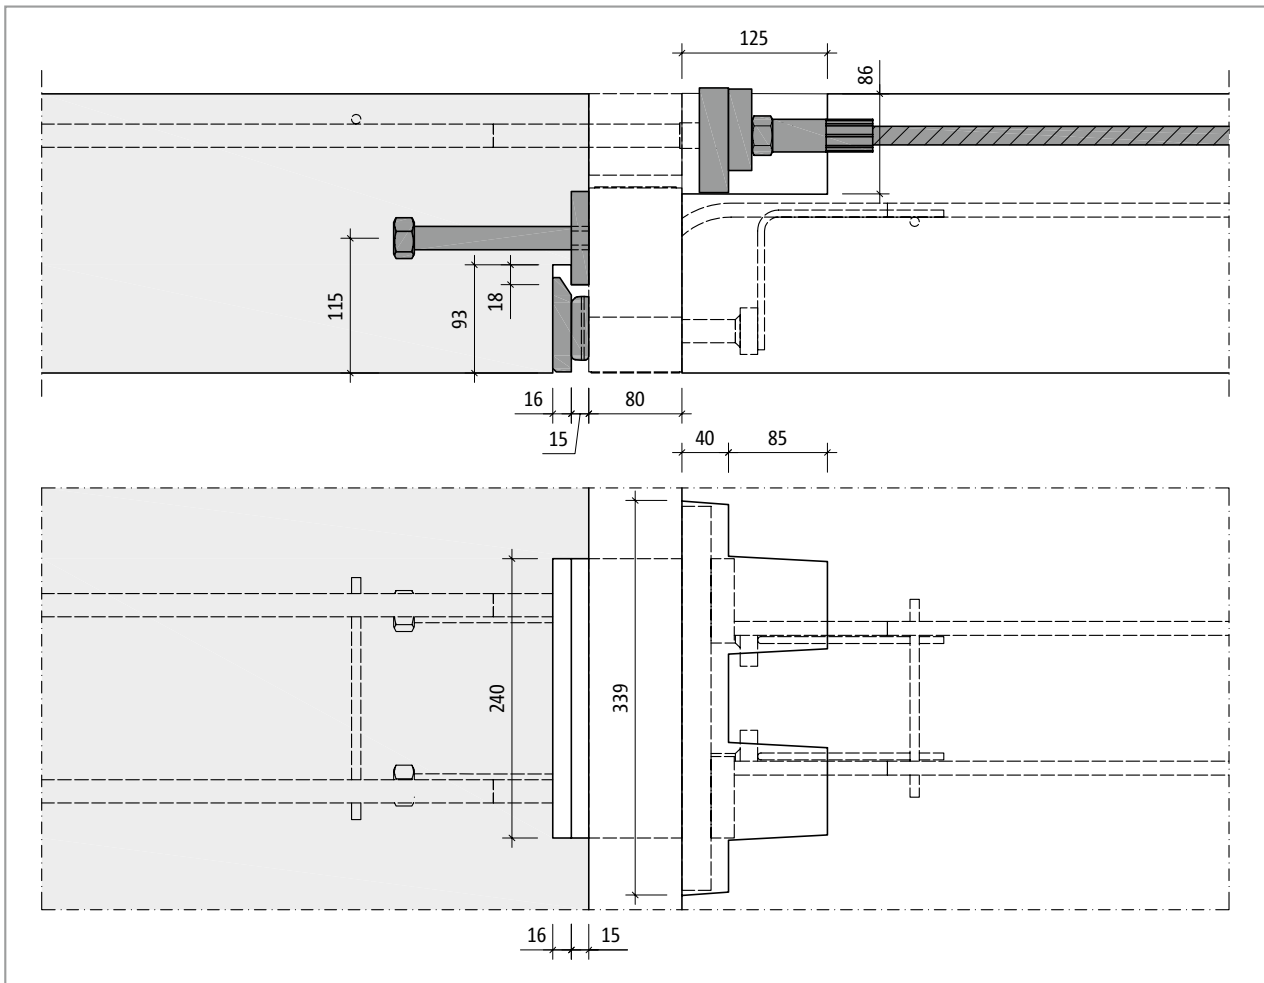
Schöck Isokorb®: Uitsparingselement (niet geleverd door Schöck)
